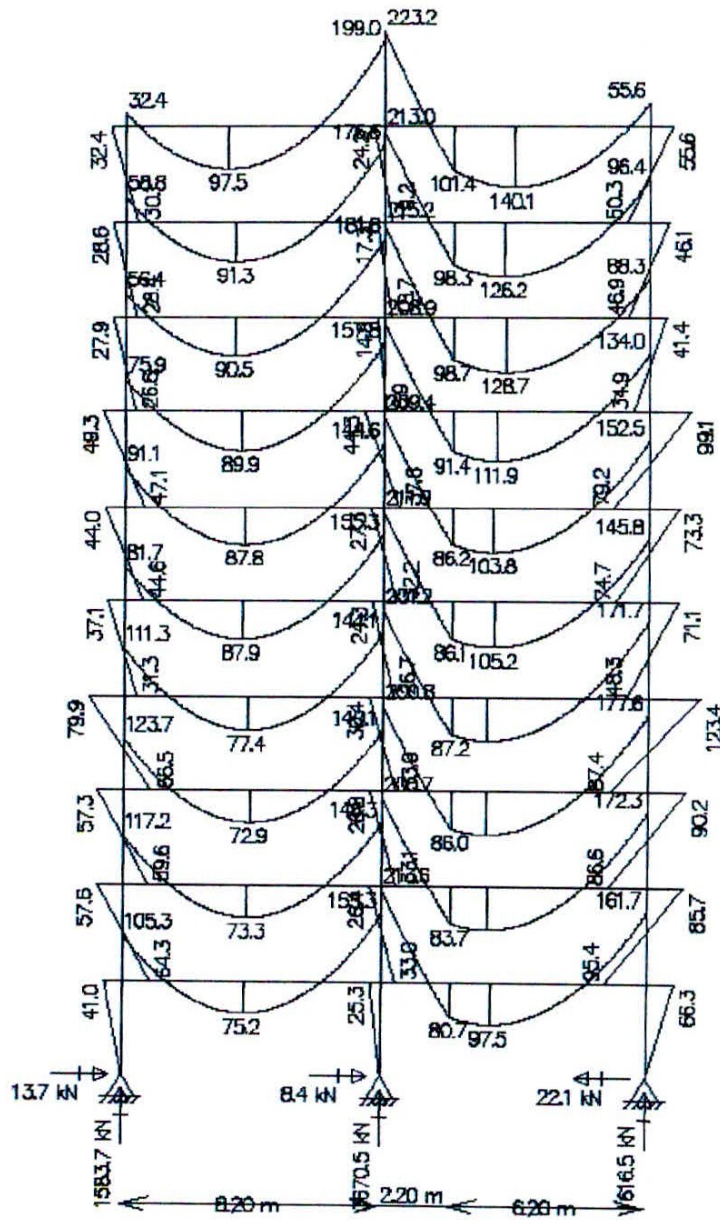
Pórtico P1 Transversal, D.M.F.
